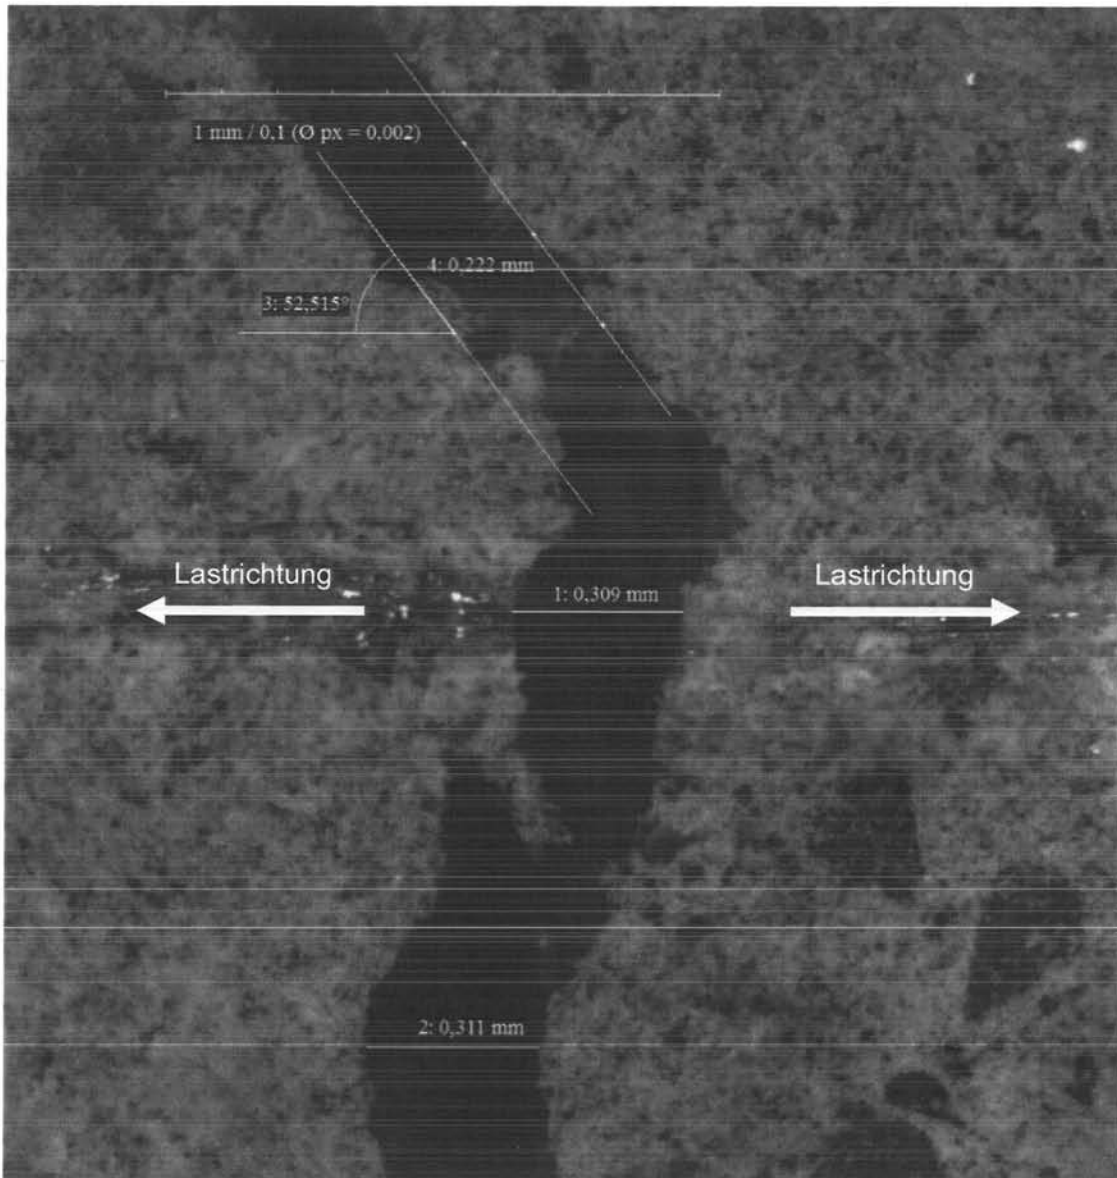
Rissbild und Rissvermessung, Bildausschnitt ca. 2 x 2mm
